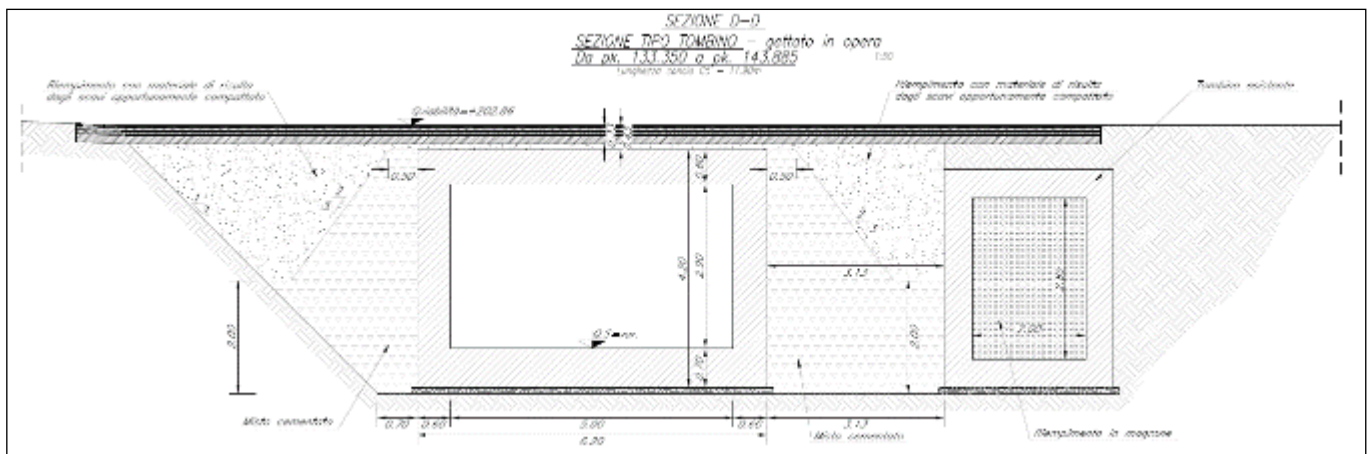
Sezione scatolare in attraversamento del fascio di binari della stazione
